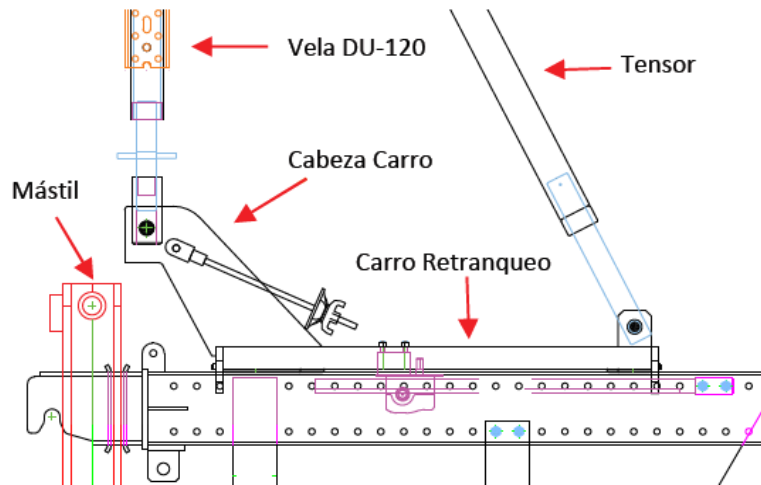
Sistema de retranqueo en consola autotrepante. Recuperado de: Ulma Construction, *Consolas autotrepantes*.
